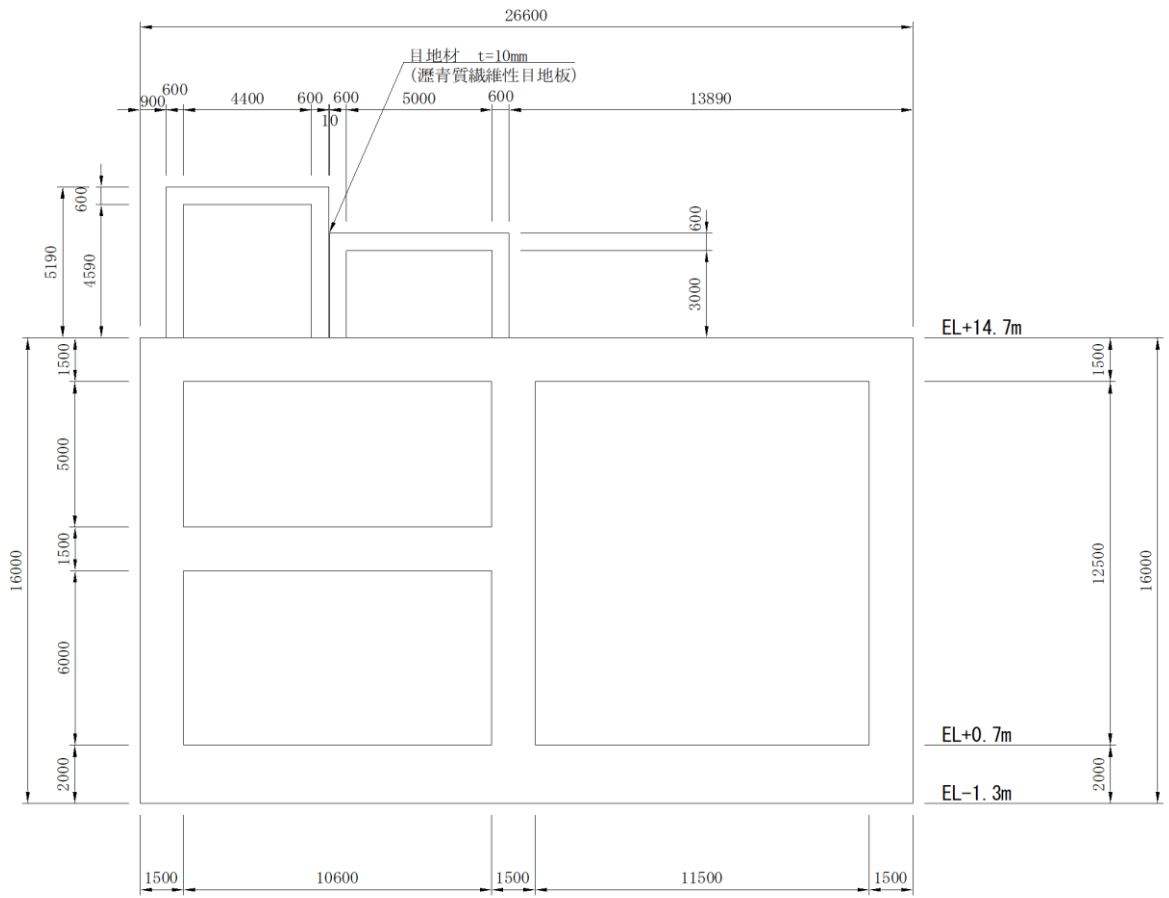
低圧原子炉代替注水ポンプ格納槽 断面図 (B-B断面)
